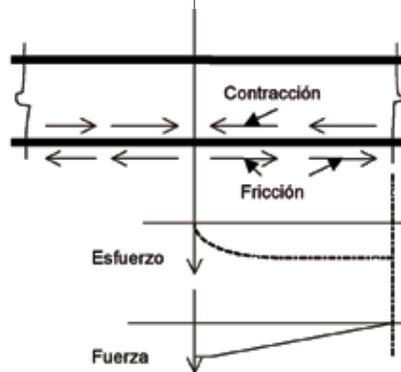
Mecanismo de fisuramiento por contracción
